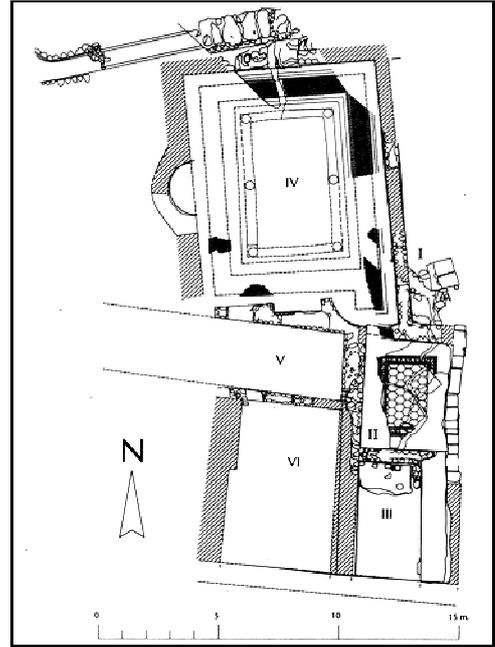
Pianta del complesso residenziale precedente al teatro.
